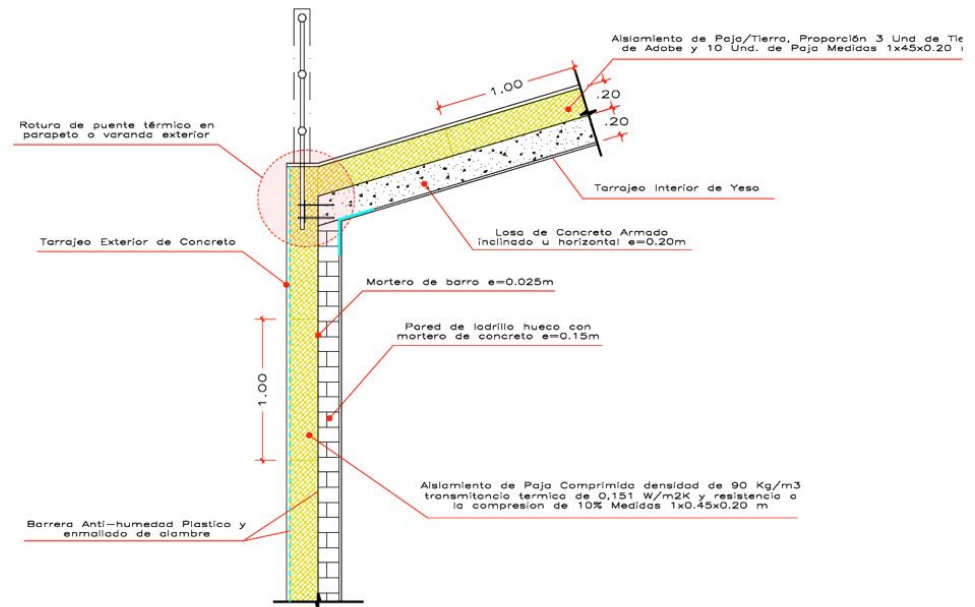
Detalle de Aislamiento SATE con fardos de Paja Comprimida en Muro Interior.
